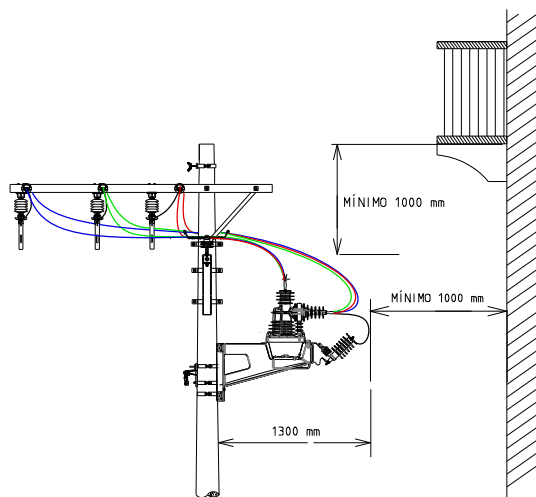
Afastamento horizontal e vertical entre ponto energizado e sacada ou janela de edificação.
